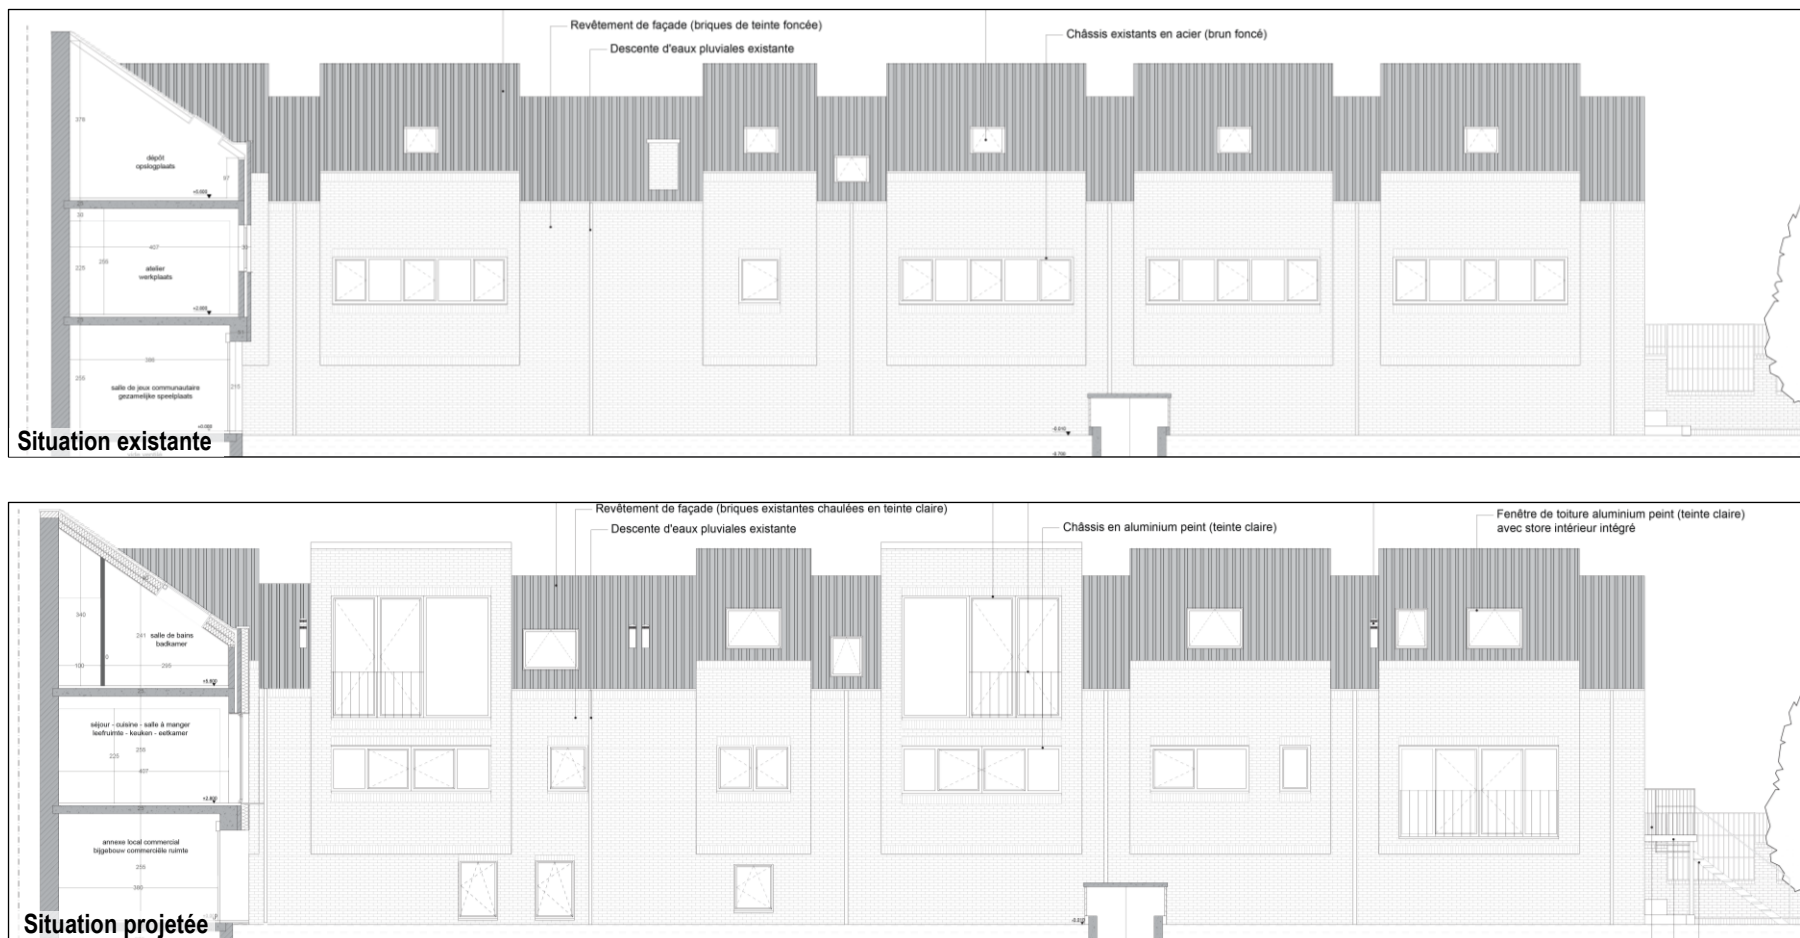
Élévation de la façade en intérieur d'îlot (Brucity, 2025)
